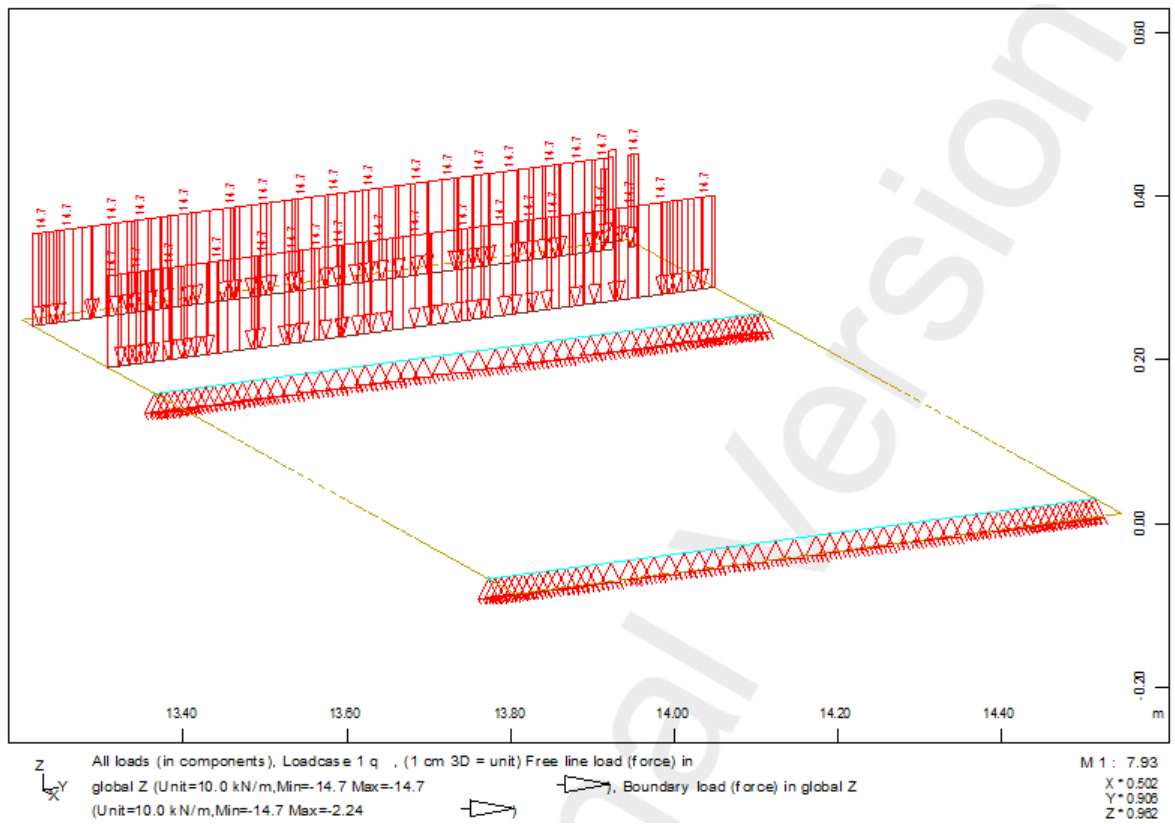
Розрахункова схема плити при консольному навантаженні
